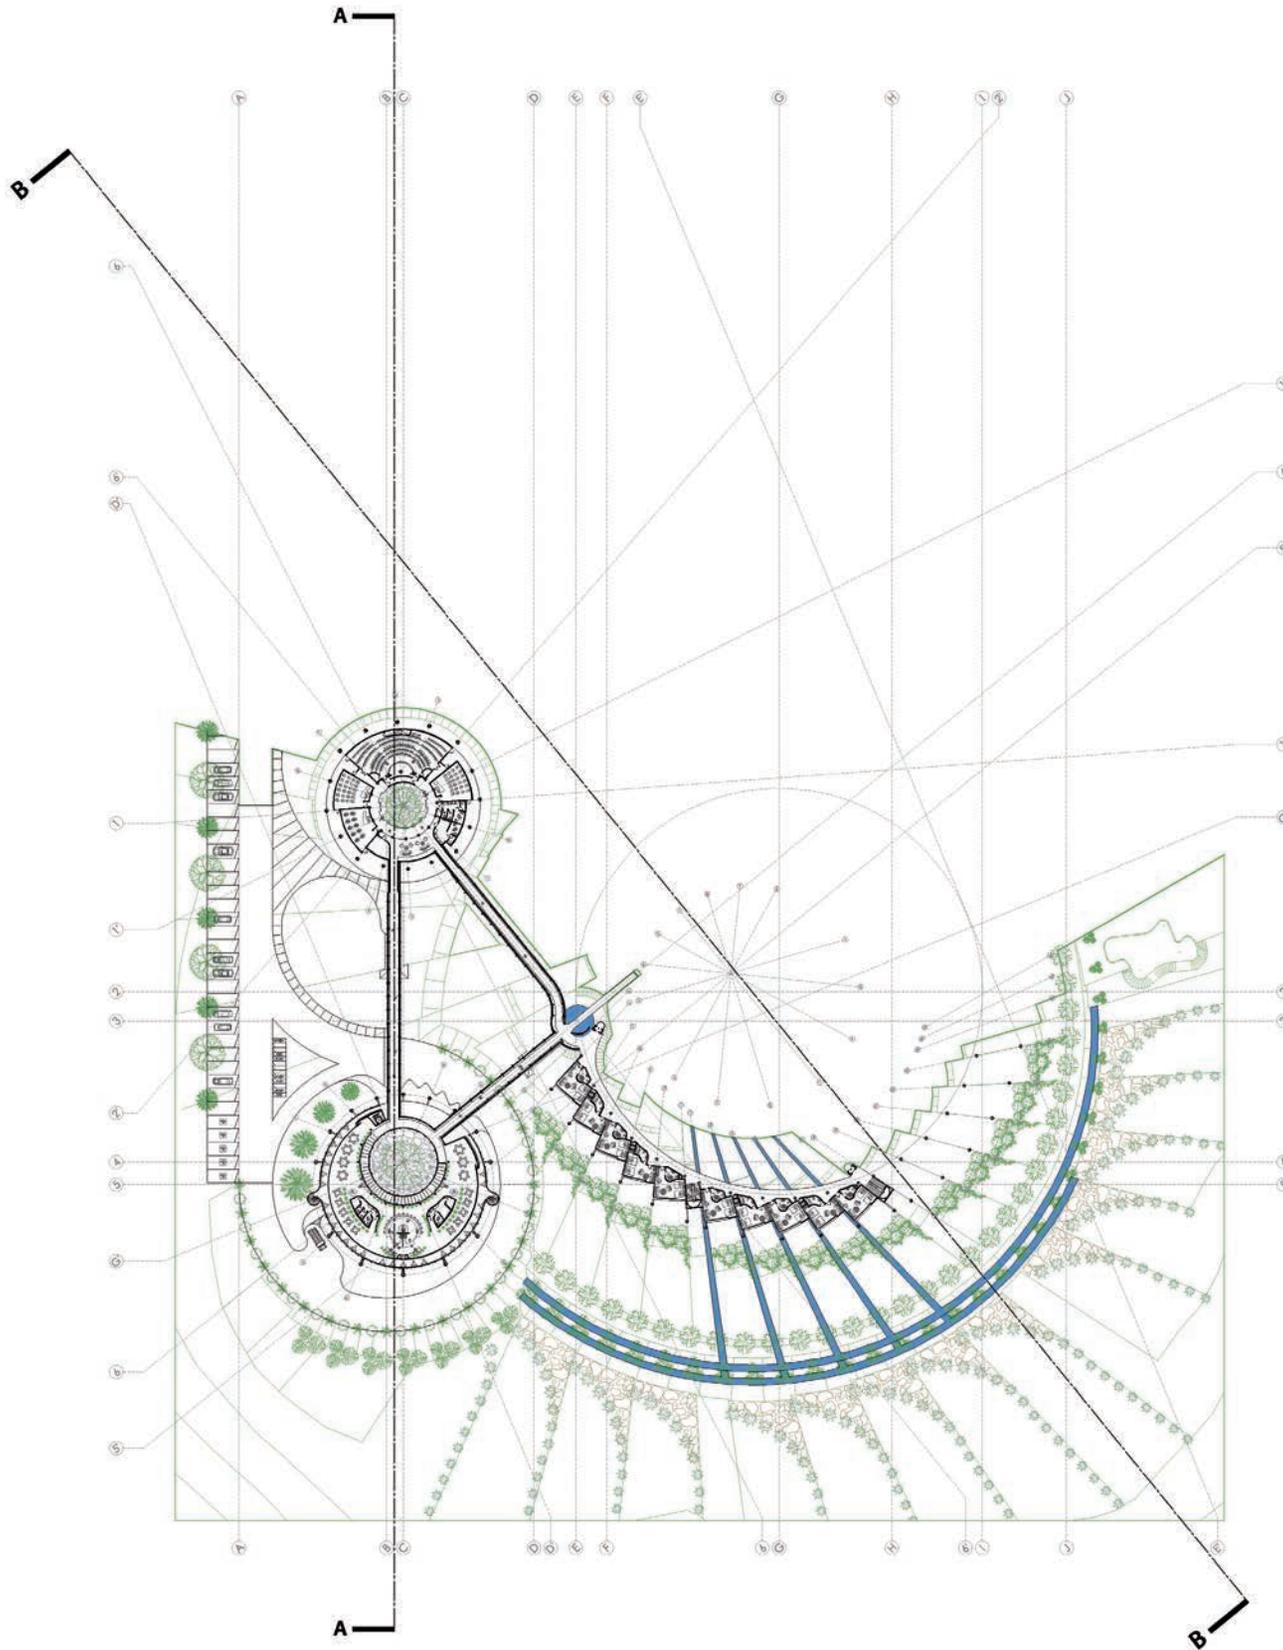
Planta Arquitectónica Nivel 2, 0+5,85 m snt. Fuente: propuesta personal, 2013.
